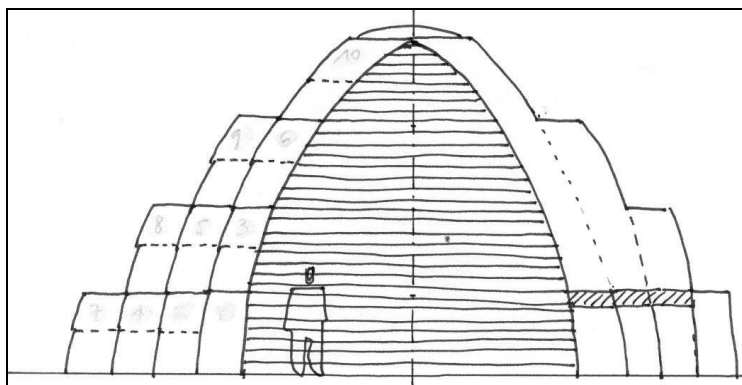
Coupe schématique des parements successifs induits par la méthode de construction par « accrétion-exhaussement » d'une capitelle ou barraca
